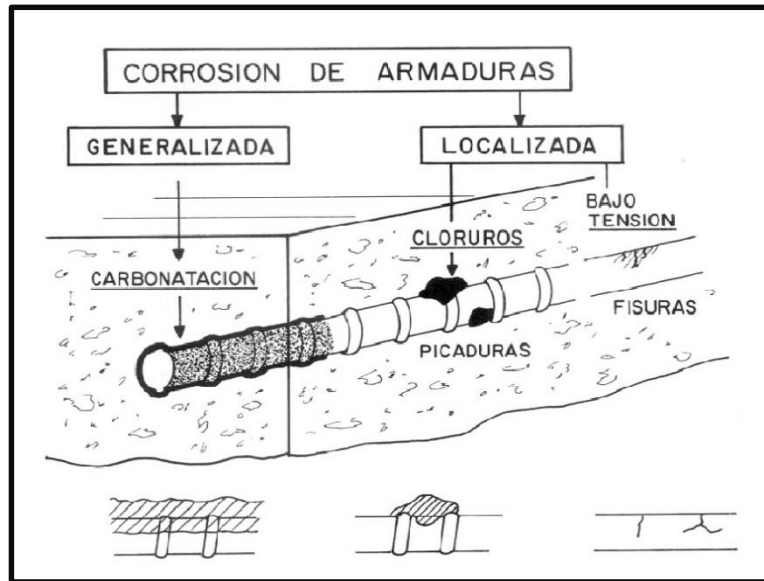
Tipos de corrosión de armaduras en el hormigón (Garcés/Climent/Zornoza,2008)
